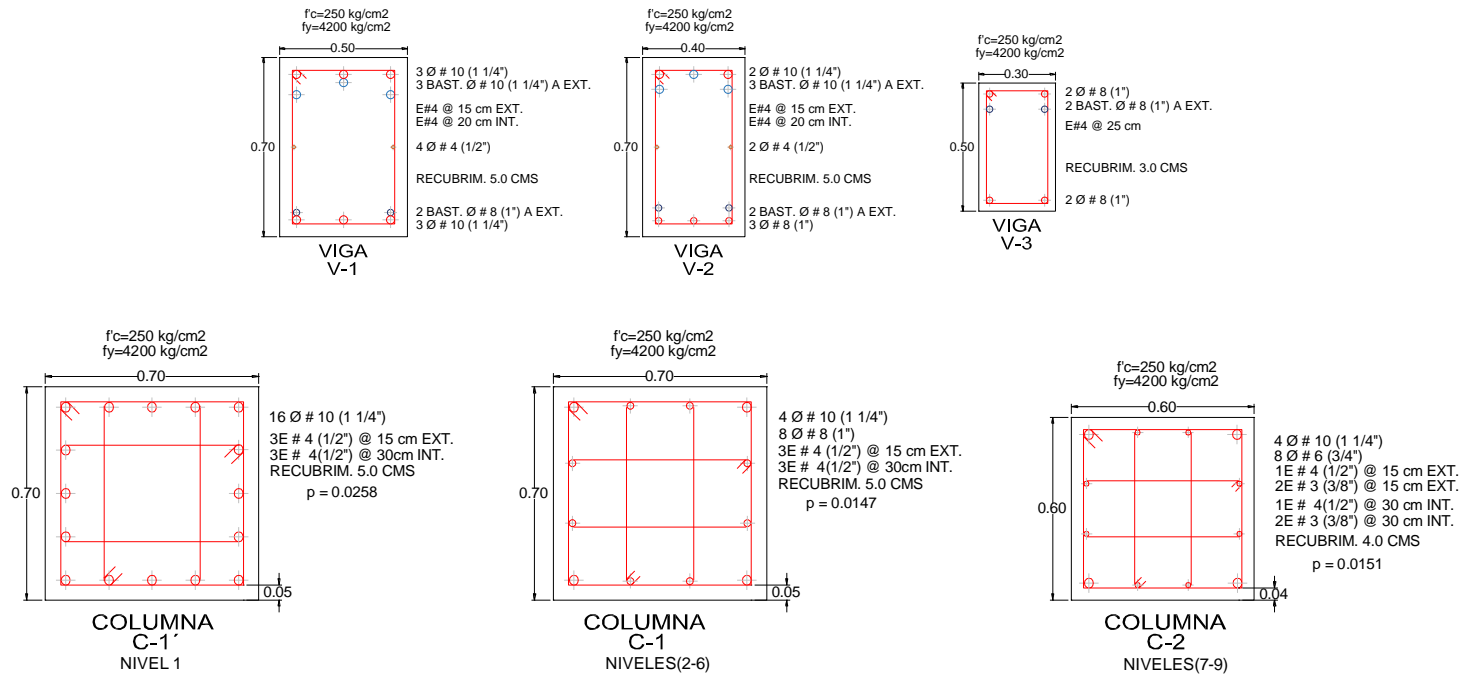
Detallado de armado de vigas y columnas del marco de 9 niveles con base a secciones gruesas (continuación).
